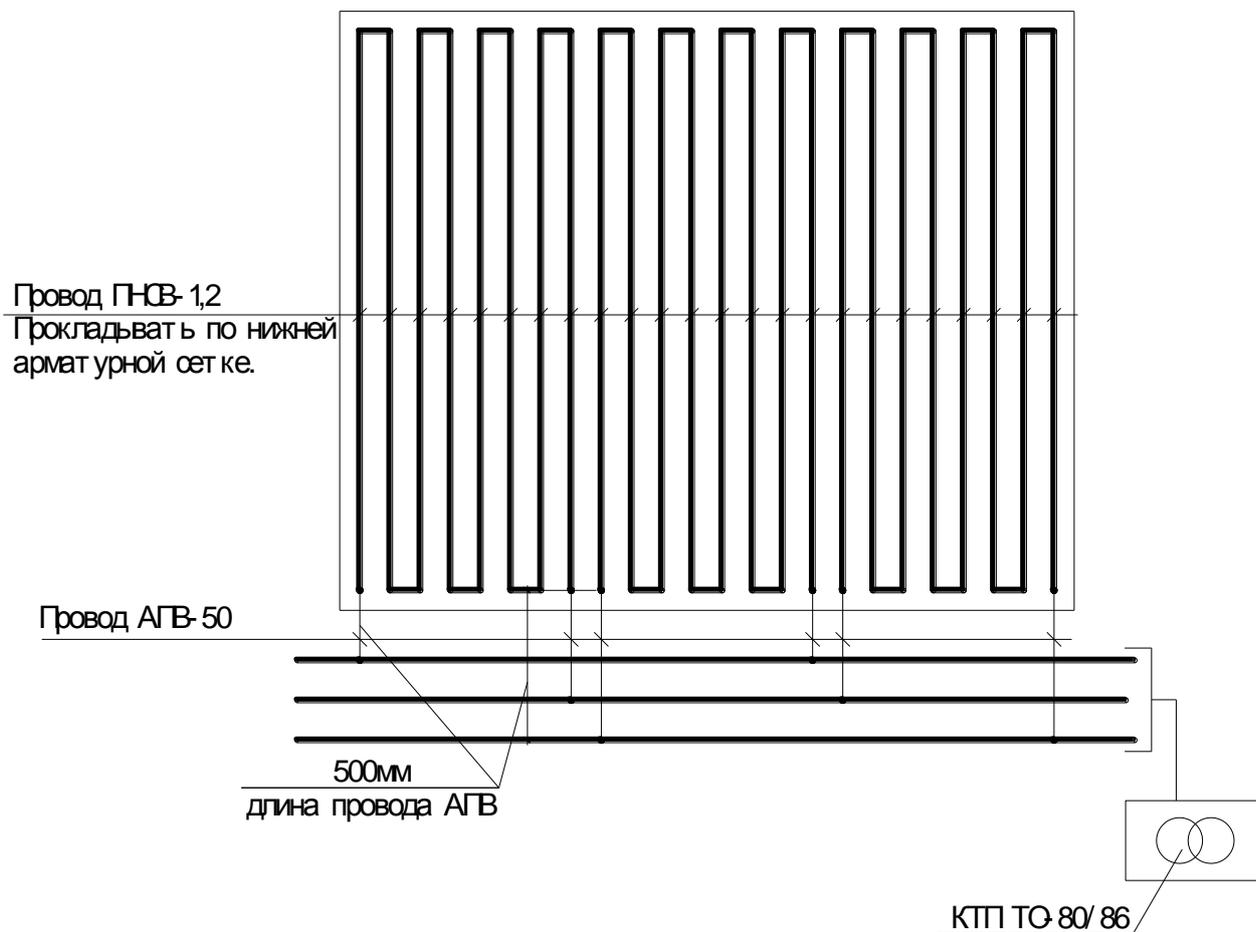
Схема раскладки греющего провода в плитах перекрытия.
